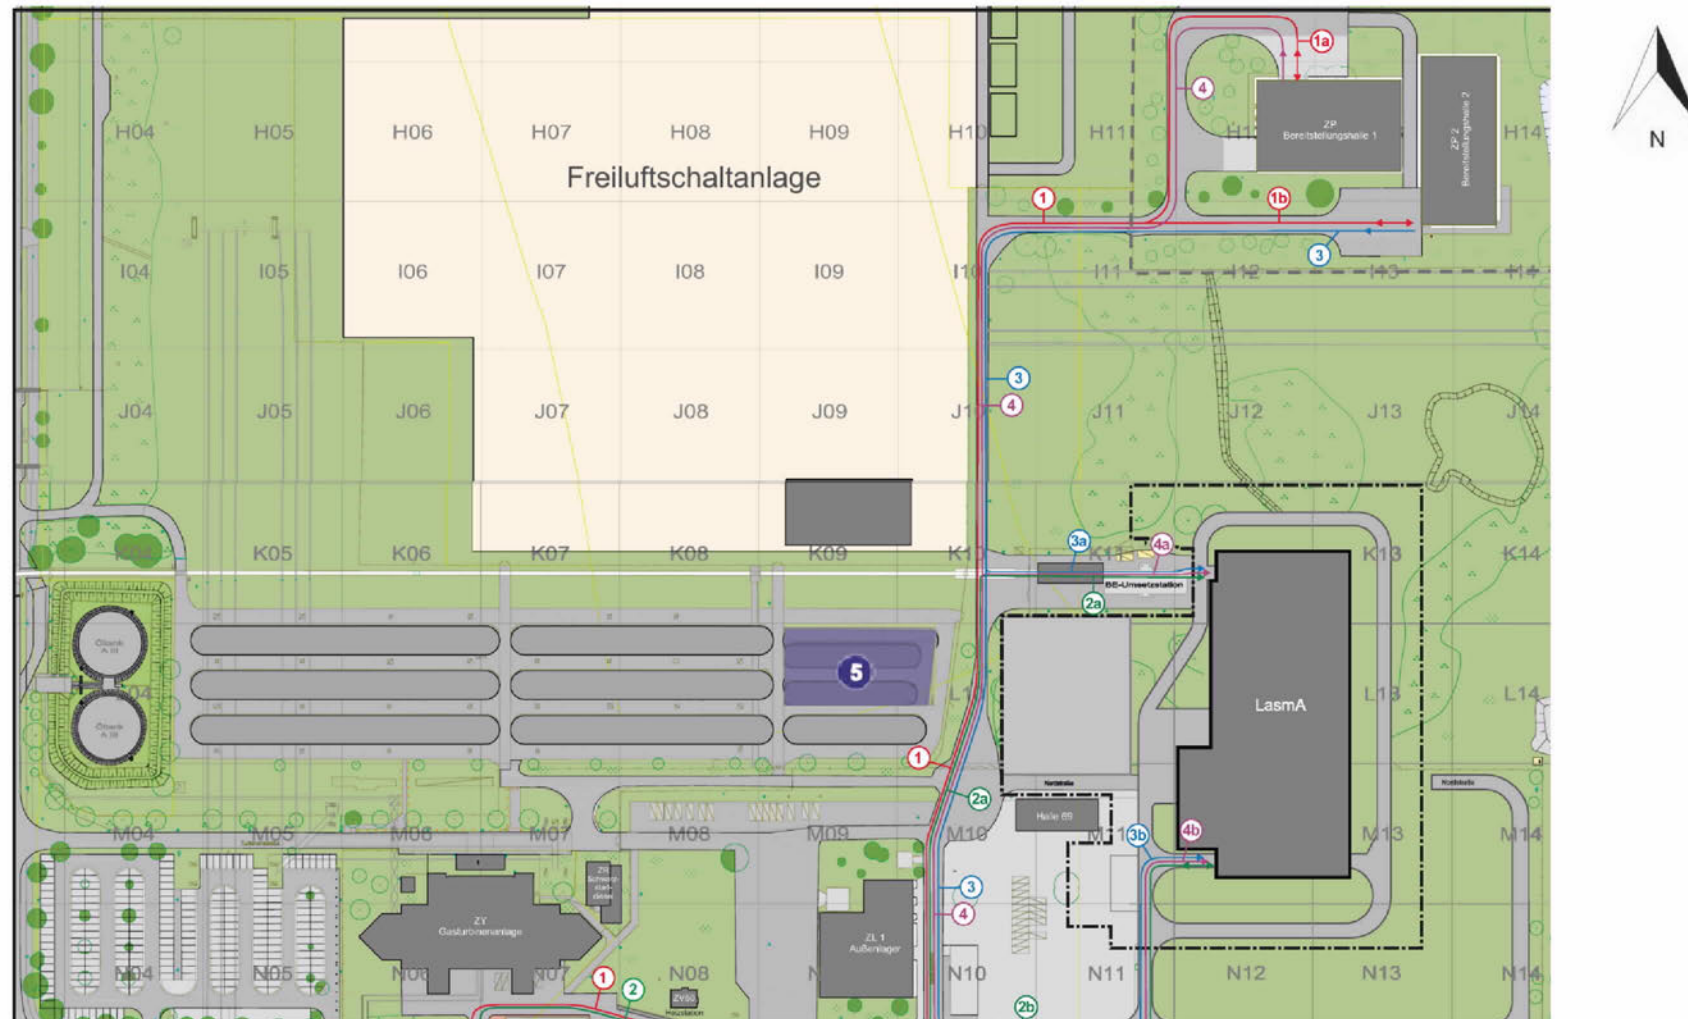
Schematischer Lageplan mit Gebäuden und Flächen (Ausschnitt, nördlicher Bereich)
